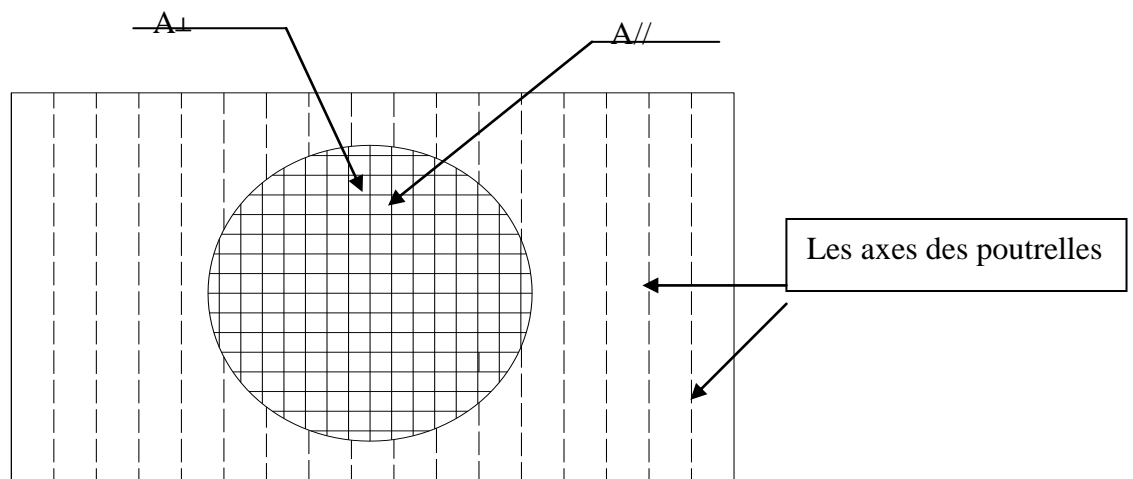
Schéma de Ferrailage de la dalle de compression.
